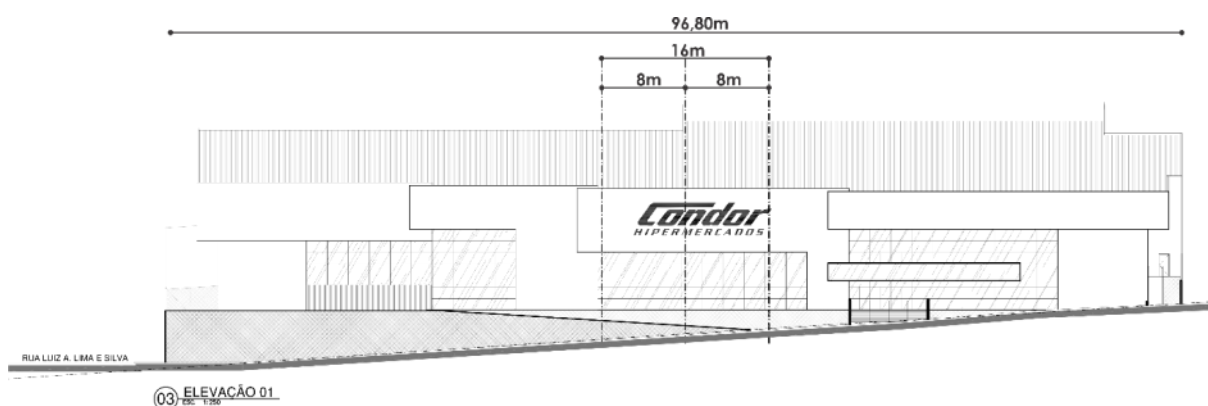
Elevação 1, Rua Pref. Faria Lima. Fonte: Projeto Arquitetônico (adaptado).
